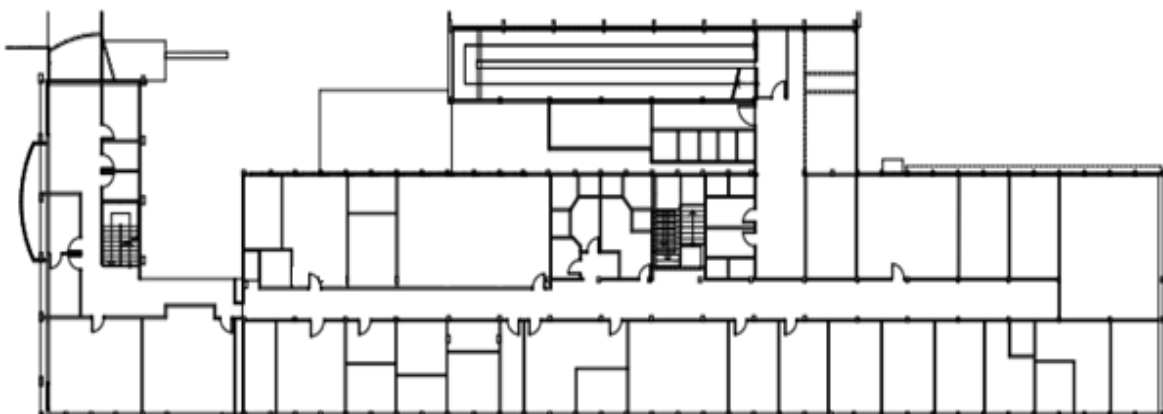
Planta baixa do terceiro pavimento da sede do HEMOSC [1]
